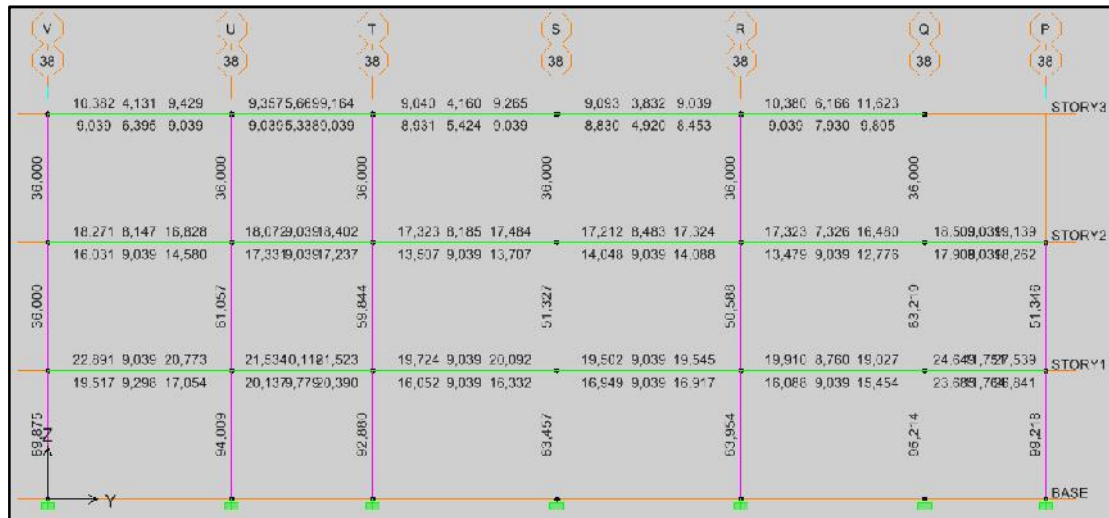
Acero en vigas pórtico 38, Consulta Externa I
